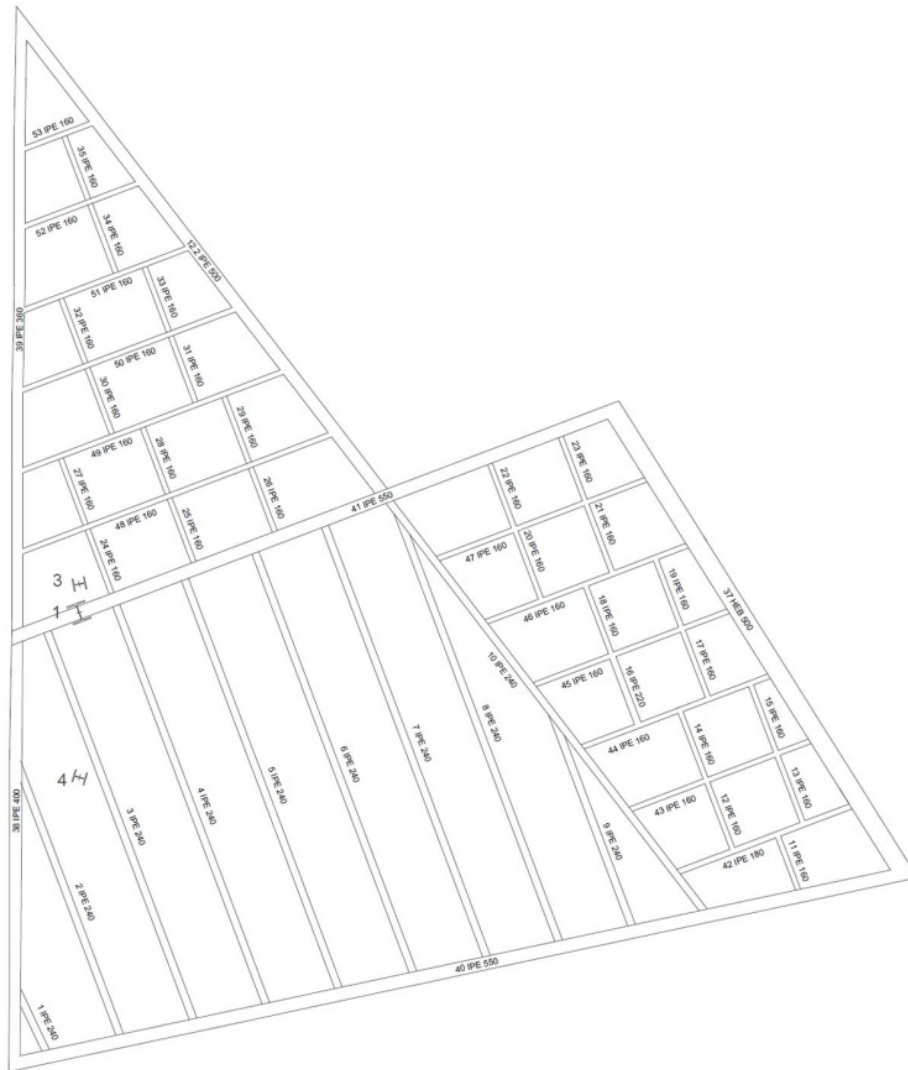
Planta de vigas numeradas con sección de acero, Dibujo propio
